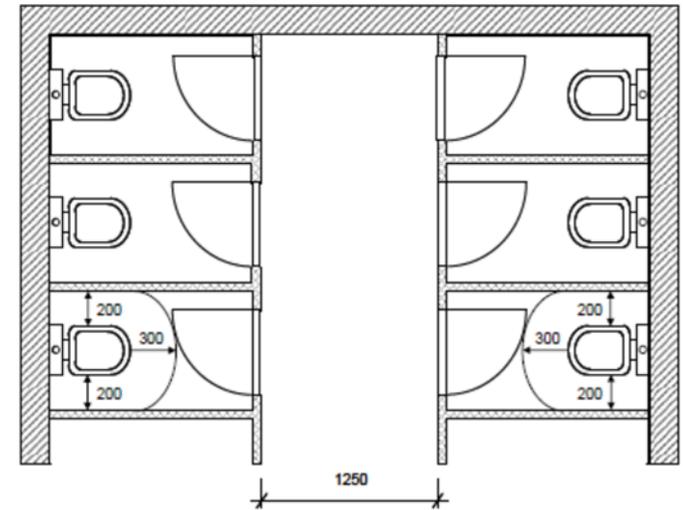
Zweibündige Toilettenanlage, Türanschlag nach innen (Maße in mm)
